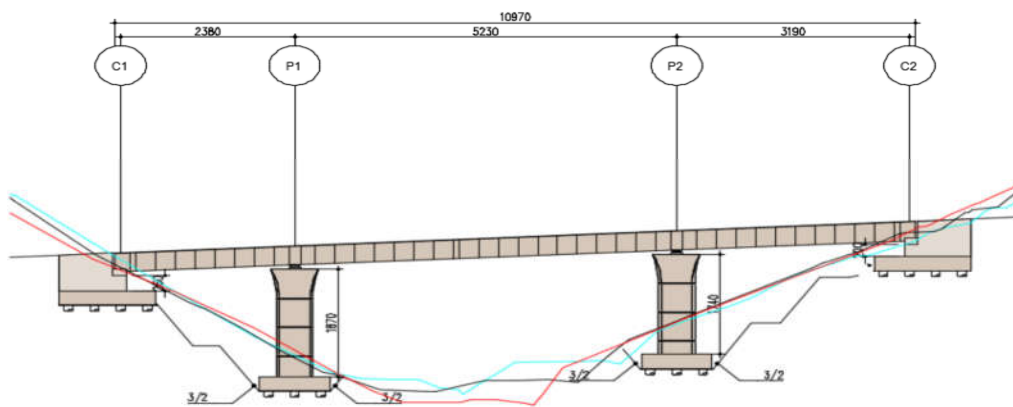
Coupe longitudinale et vue en élévation de la variante
